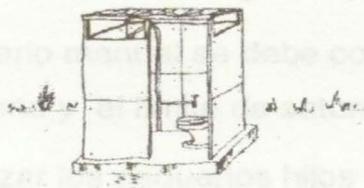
Construcción de las instalaciones sanitarias (Unifano).
